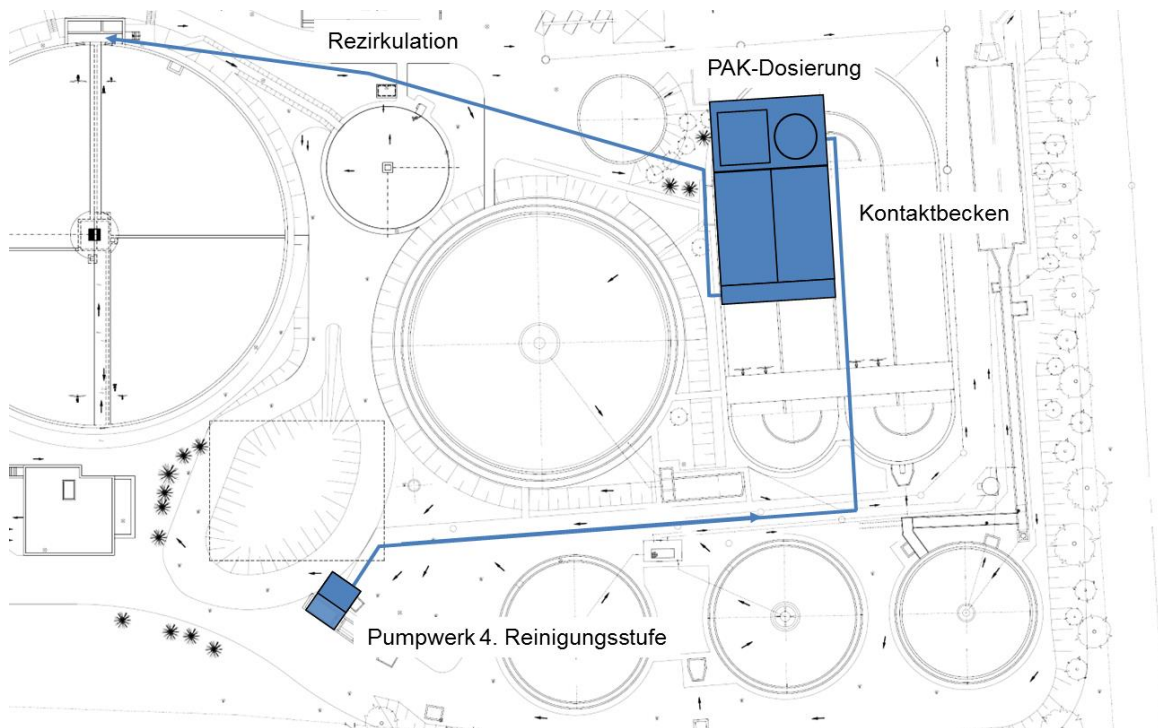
Schematische Darstellung der vierten Reinigungsstufe im Lageplanausschnitt (Variante 3)
